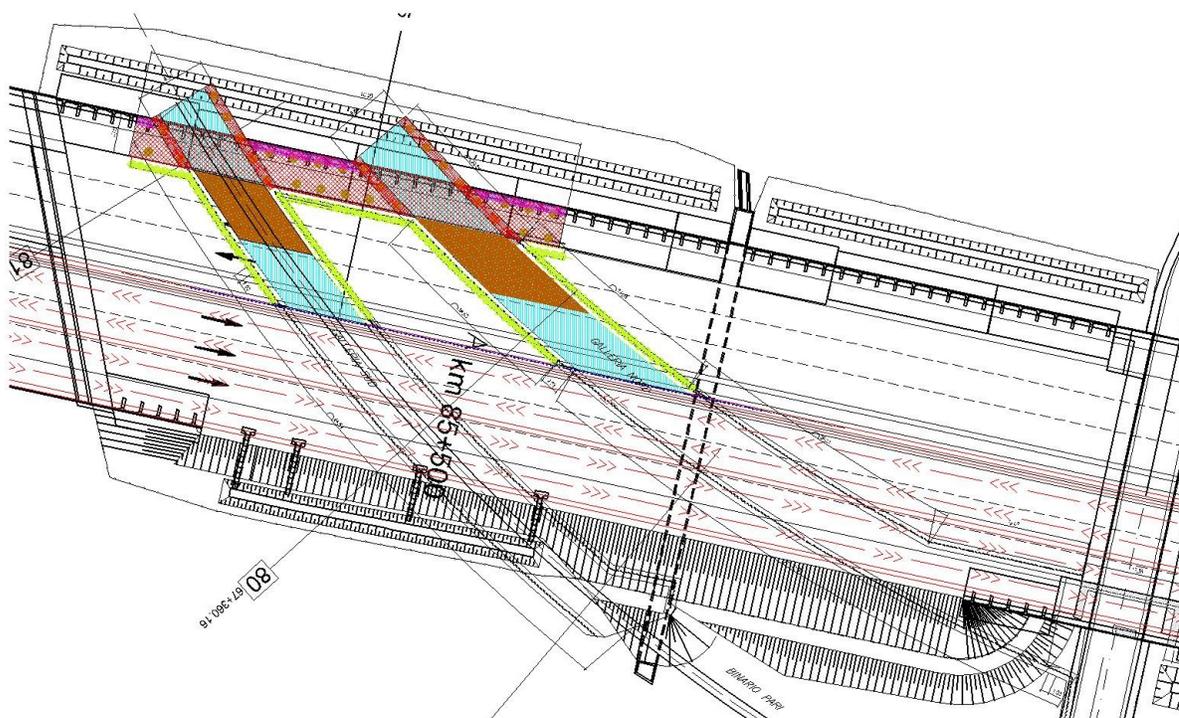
Pianta delle sequenze lavorative di fase 1.
